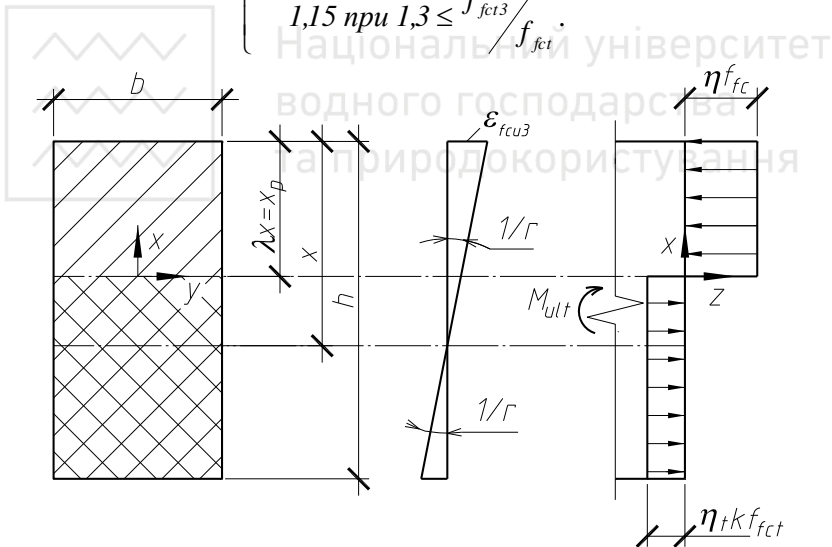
Схема зусиль та епюри напружень у перерізі, нормальному до поздовжньої осі згинального фібробетонного елемента прямокутного перерізу без поздовжнього армування при розрахунку його за міцністю
